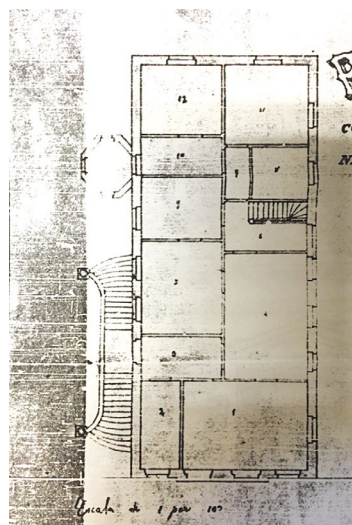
Projeto de construção. Primeiro pavimento.¹⁷²
